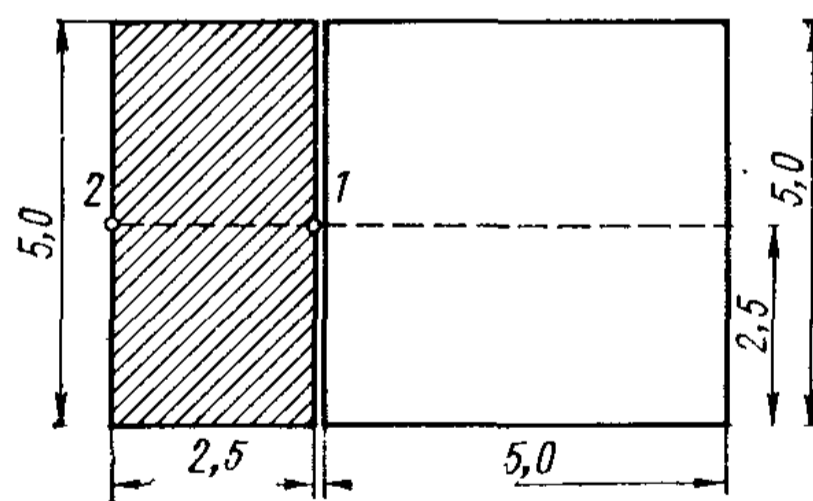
К примеру расчета осадок фундаментов по методу угловых точек
